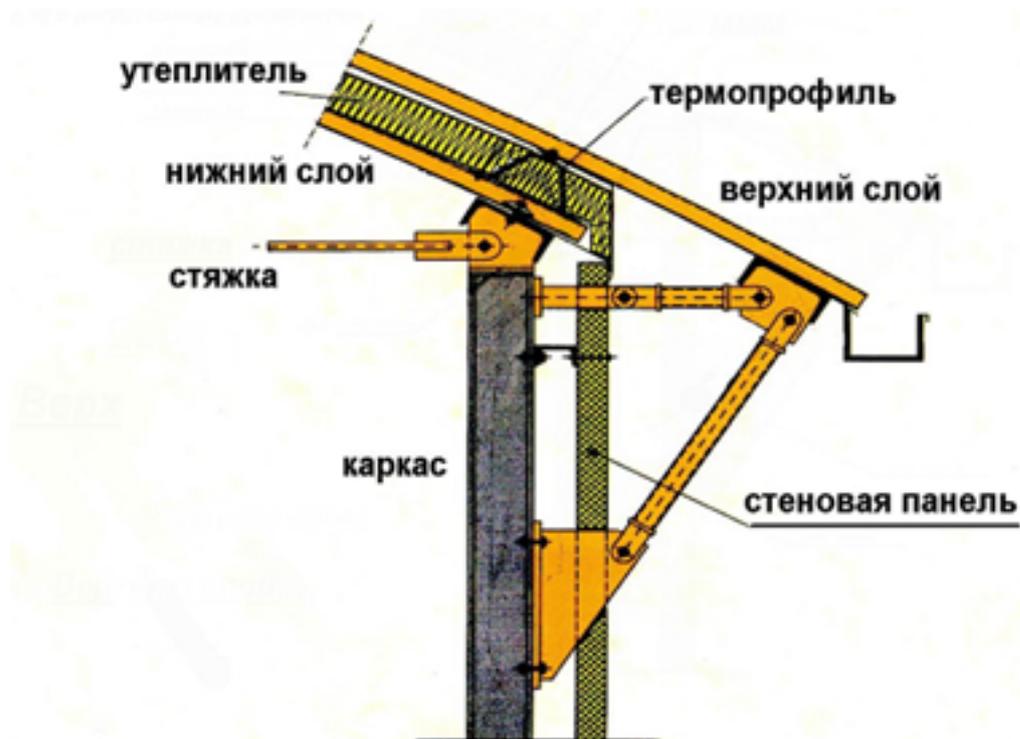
Схема двухслойного несущего арочного покрытия из тонколистового металлического профнастила
